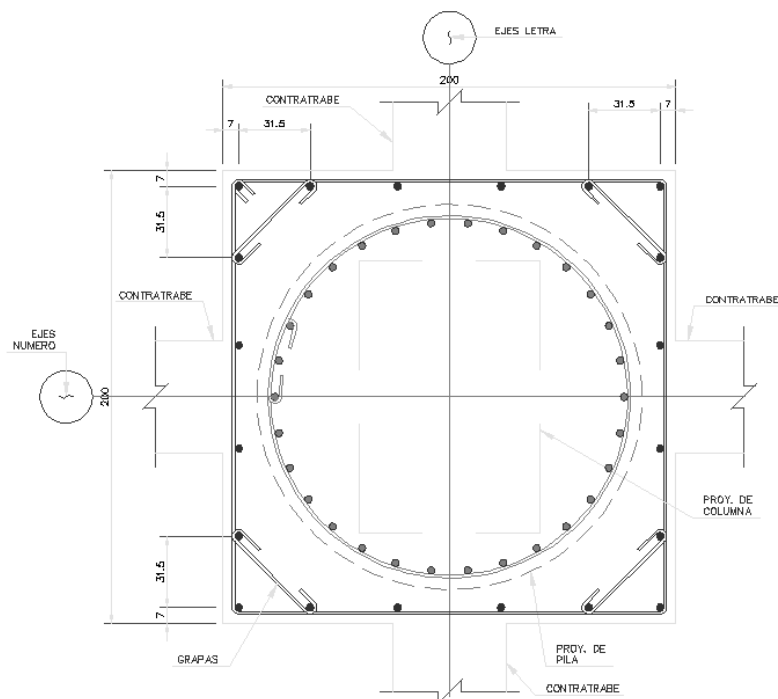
Armado de acero de dados de cimentación. Colinas de Buen S.A de C.V. (2016).
